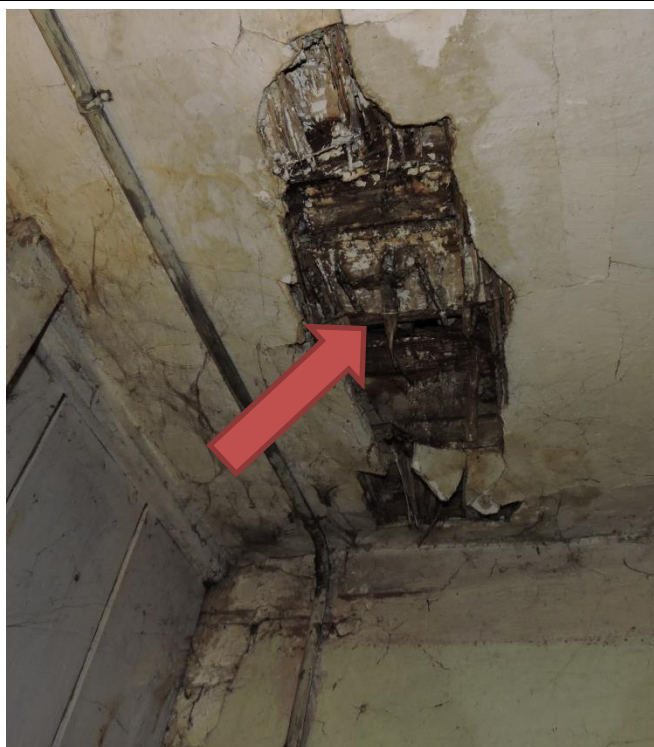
Okładzina sufitowa w stanie kompletnej degradacji. Widoczne prze wilgocenie elementów drewnianych.
